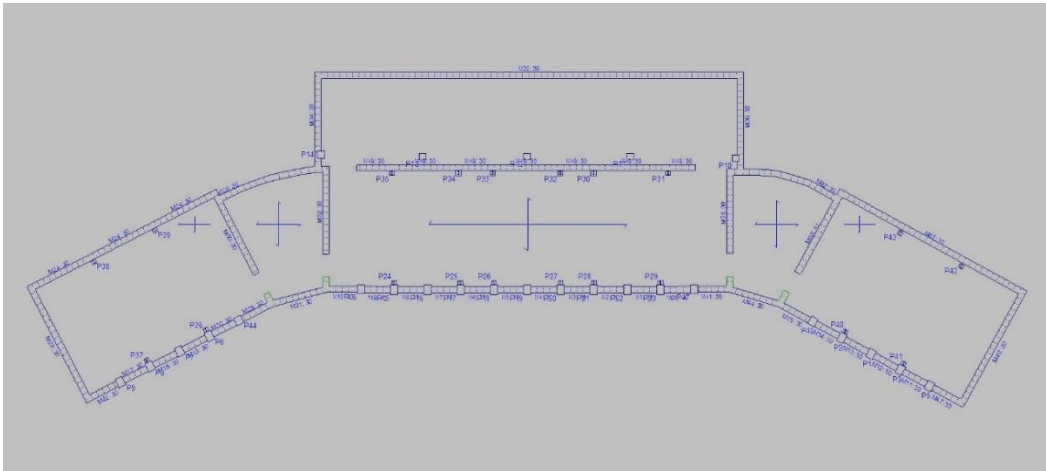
Planta 2 del modelo de 5 plantas simplificado
